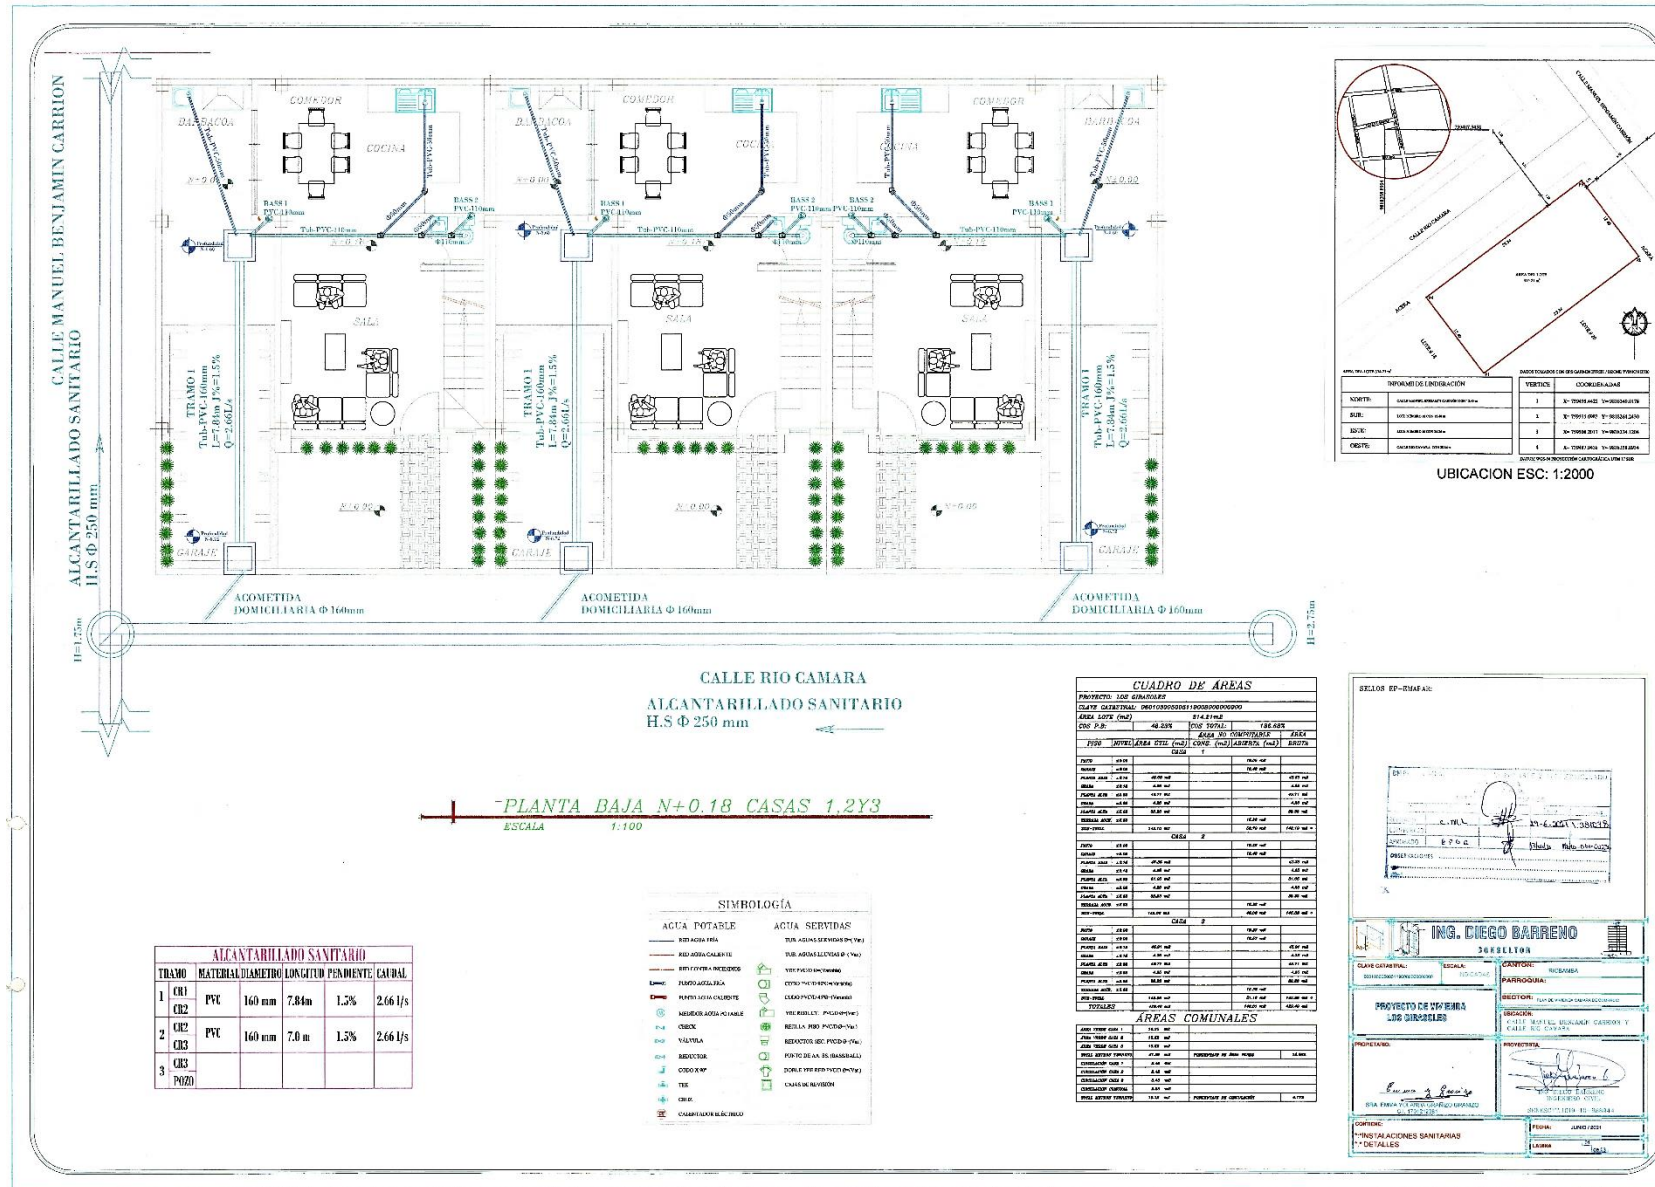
Plano instalaciones hidrosanitarias Alcantarillado Sanitario
